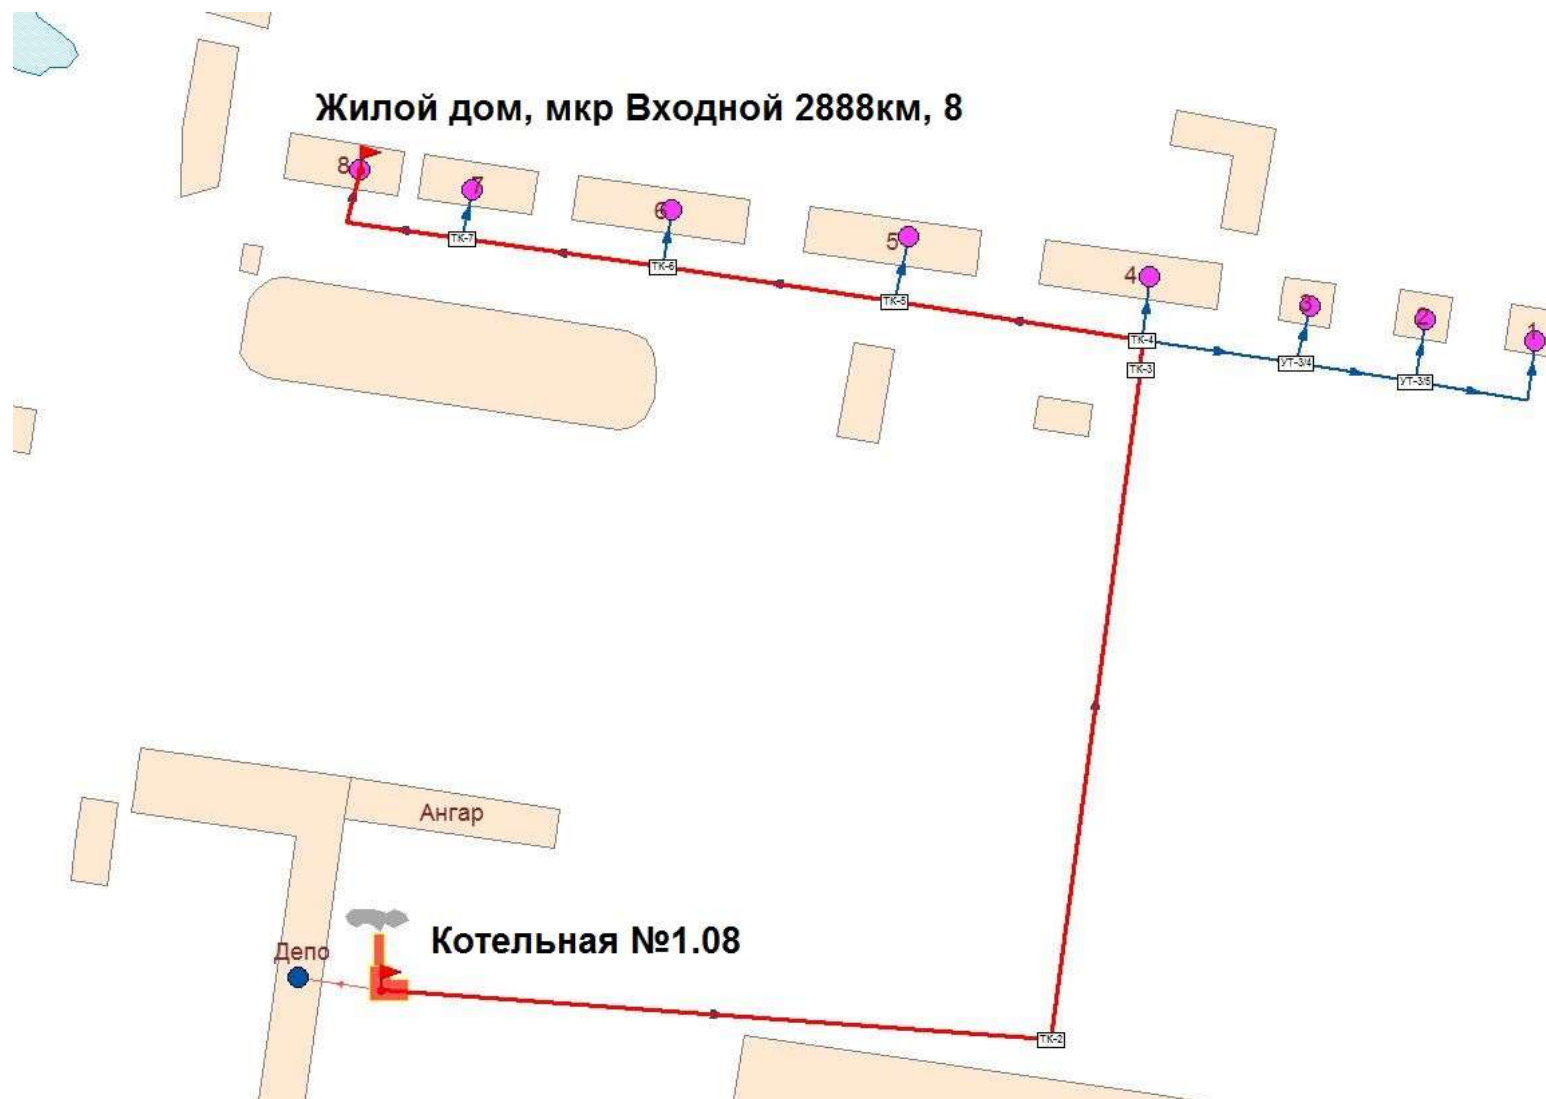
Трассировка теплопровода от Котельной 1.08 до жилого дома, мкр Входной 2888 км, 8
